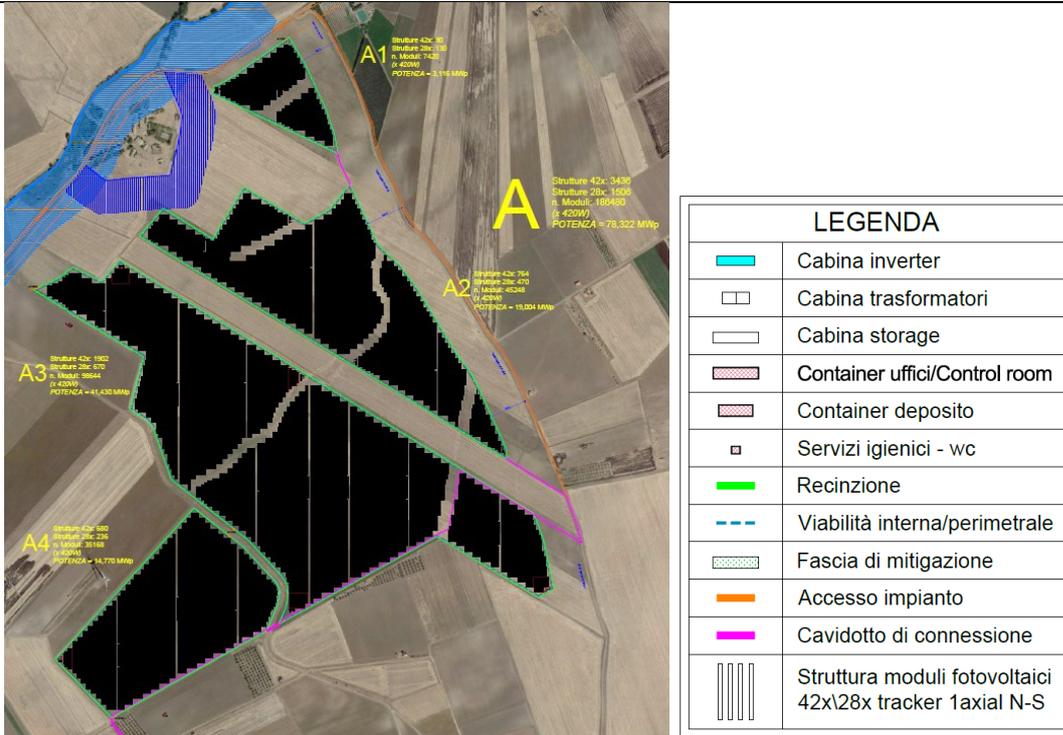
Layout di impianto dell’Area A1-A2 e A3
